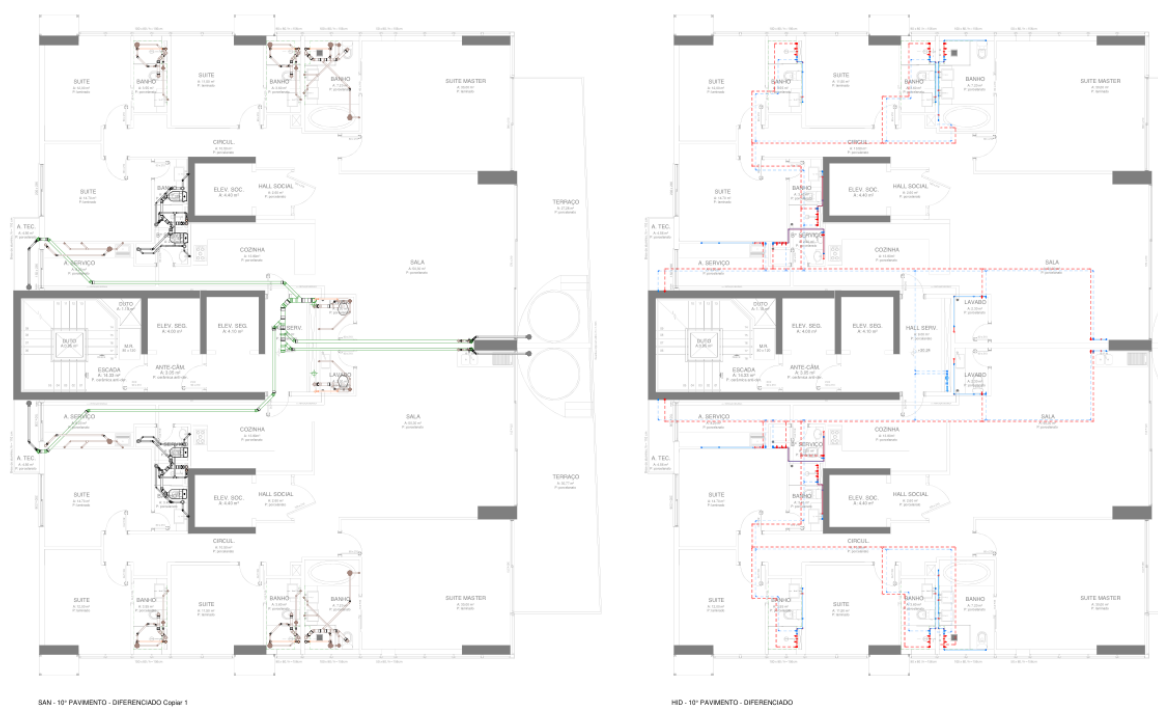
Caracterização do Pavimento Tipo diferenciado – 10º pavimento
